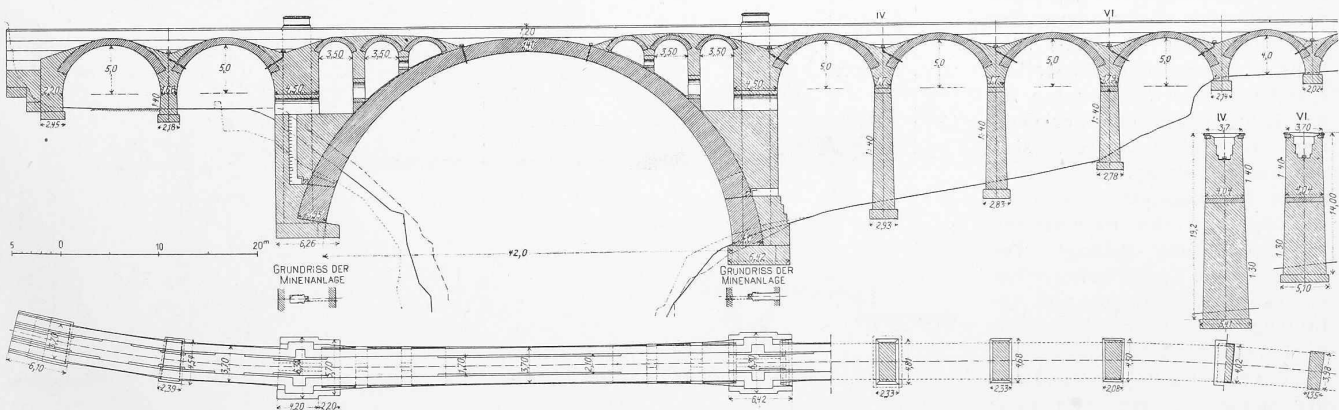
Längenschnitt, Grundriss und Pfeiler der Solisbrücke. — Masstab 1 : 700.
